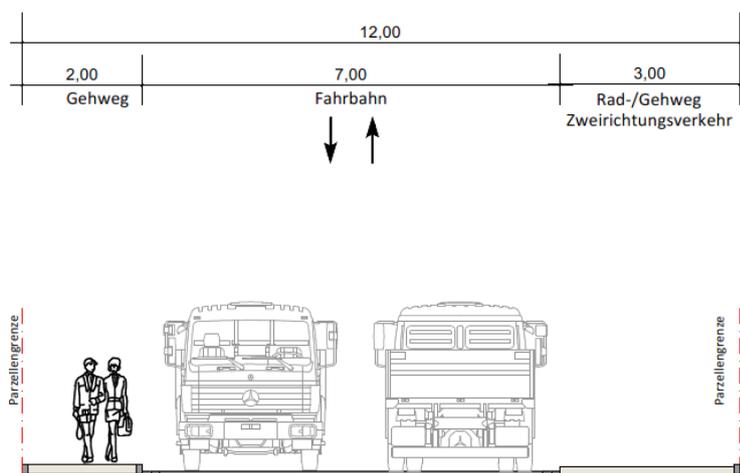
Haupterschließungsstraße im südlichen Plangebiet
